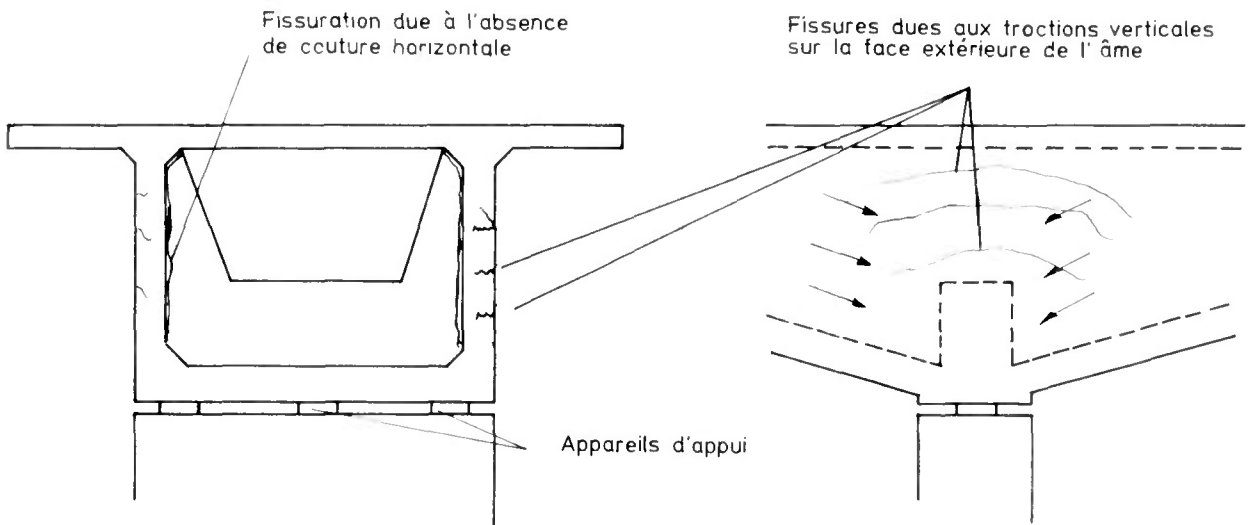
Exemple de désordres constatés au droit d'une entretoise sur appui.
